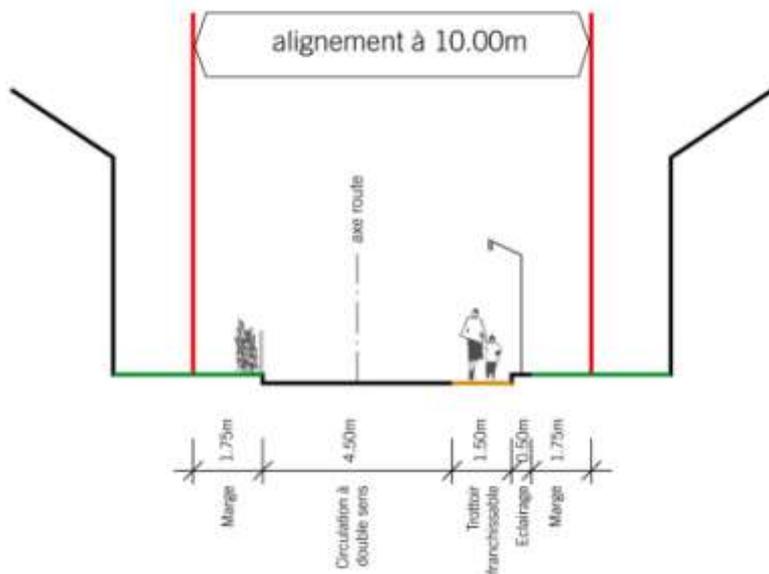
Profil type pour route collectrice ou de desserte sans stationnement
